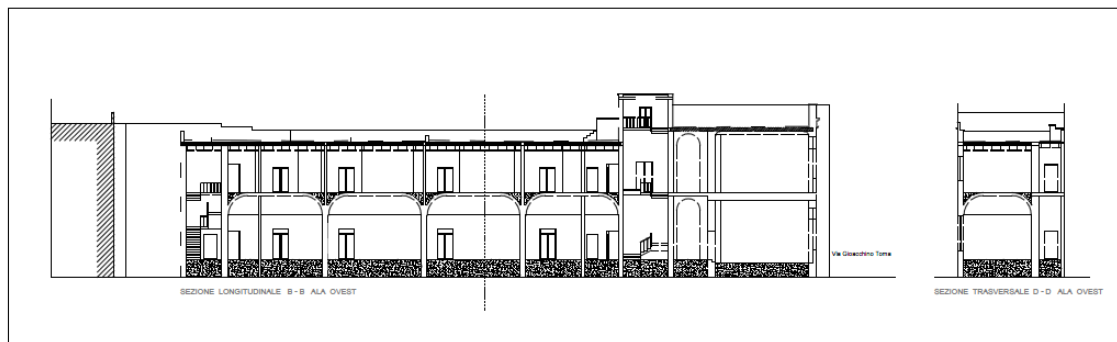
Sezione longitudinale e trasversale ala ovest dell'edificio.
